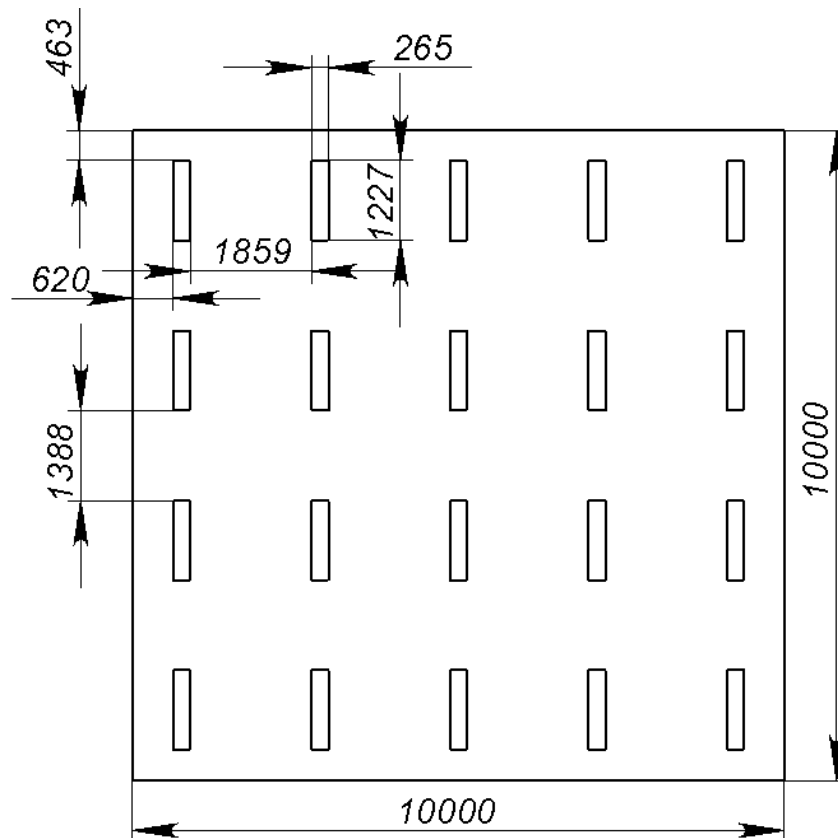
План помещения и размещения светильников с люминесцентными лампами
